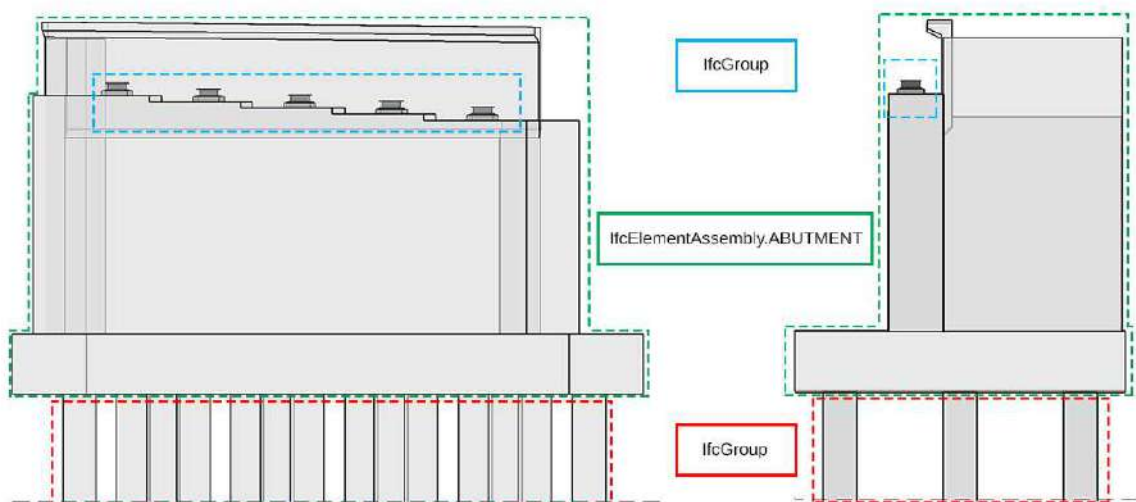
Esempificazione dell'aggregazione degli elementi della spalla del ponte.
